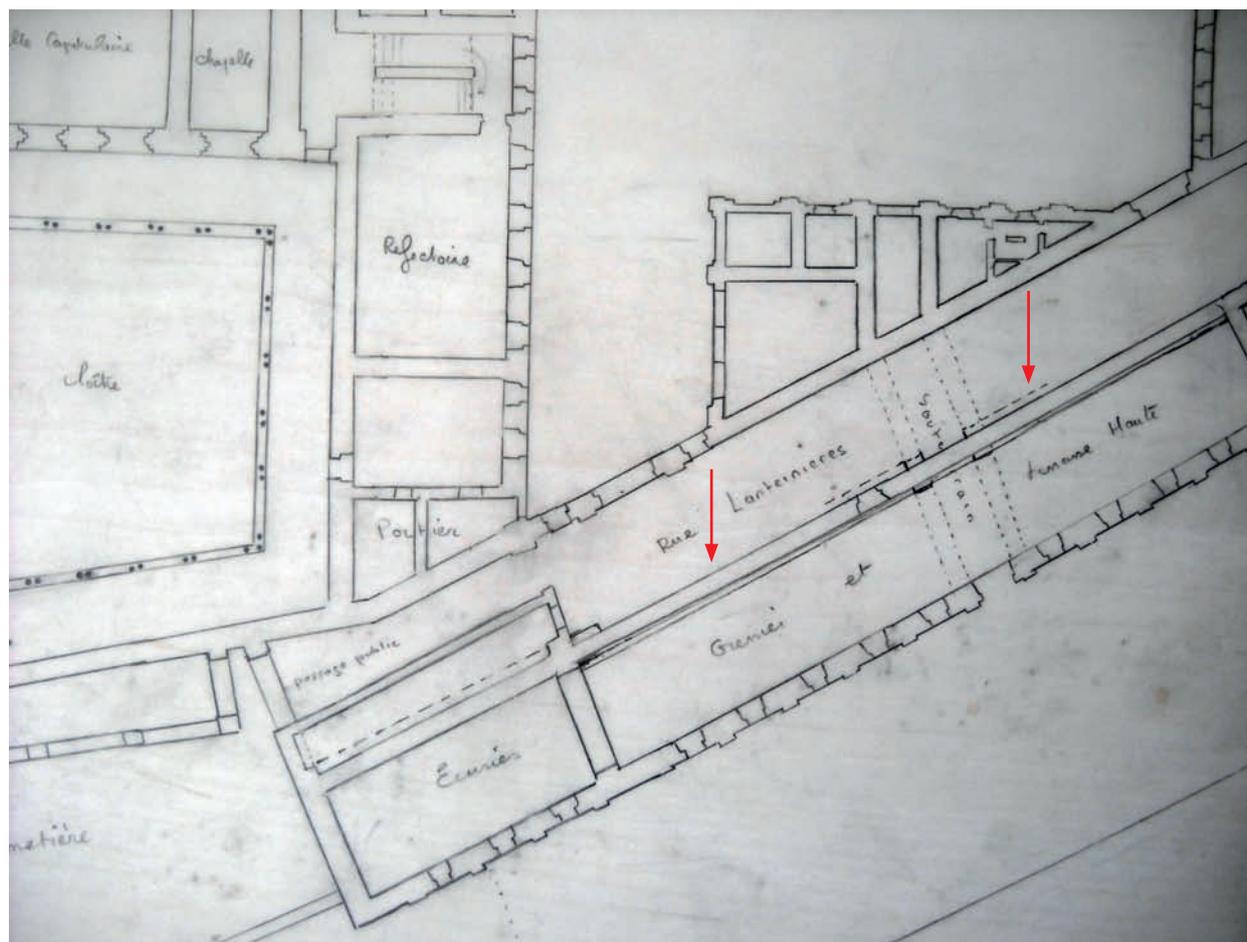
TRONÇON DE LA MURAILLE DEVANT LE COUVENT DE LA DAURADE. Copie sur calque du plan de Franque conservé aux A.D. Hérault, Cote C 498-1.
